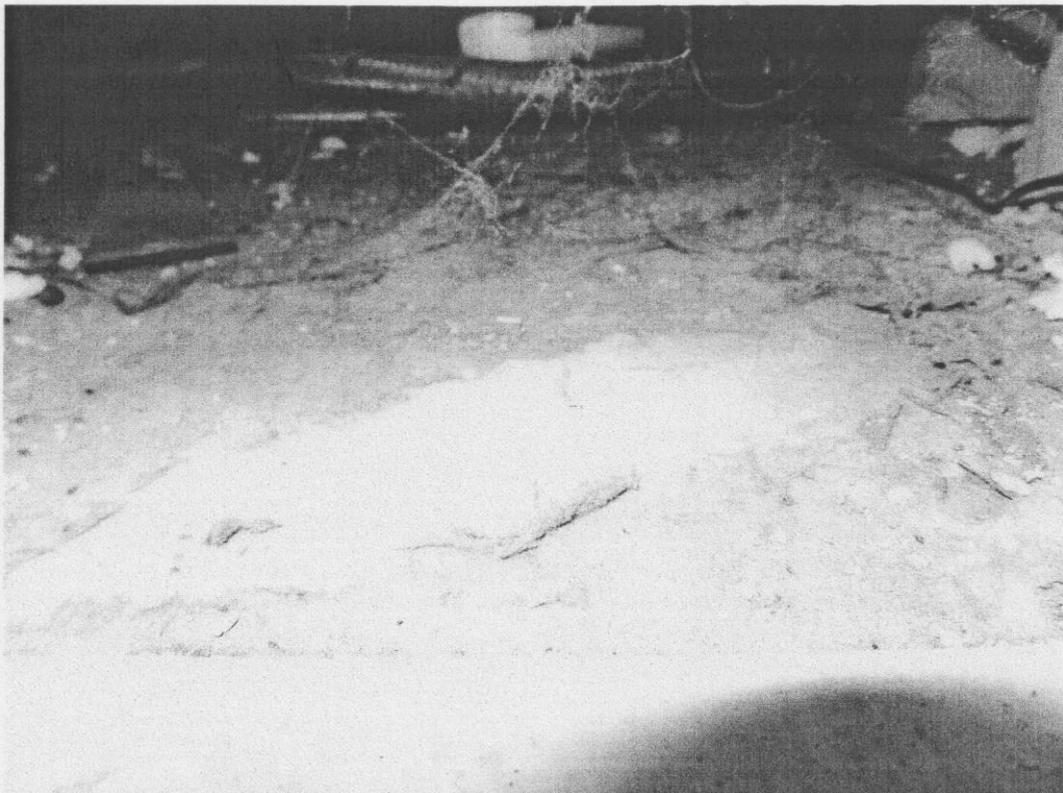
Blick auf den Boden direkt hinter der Revisionsöffnung aus Bild 64
